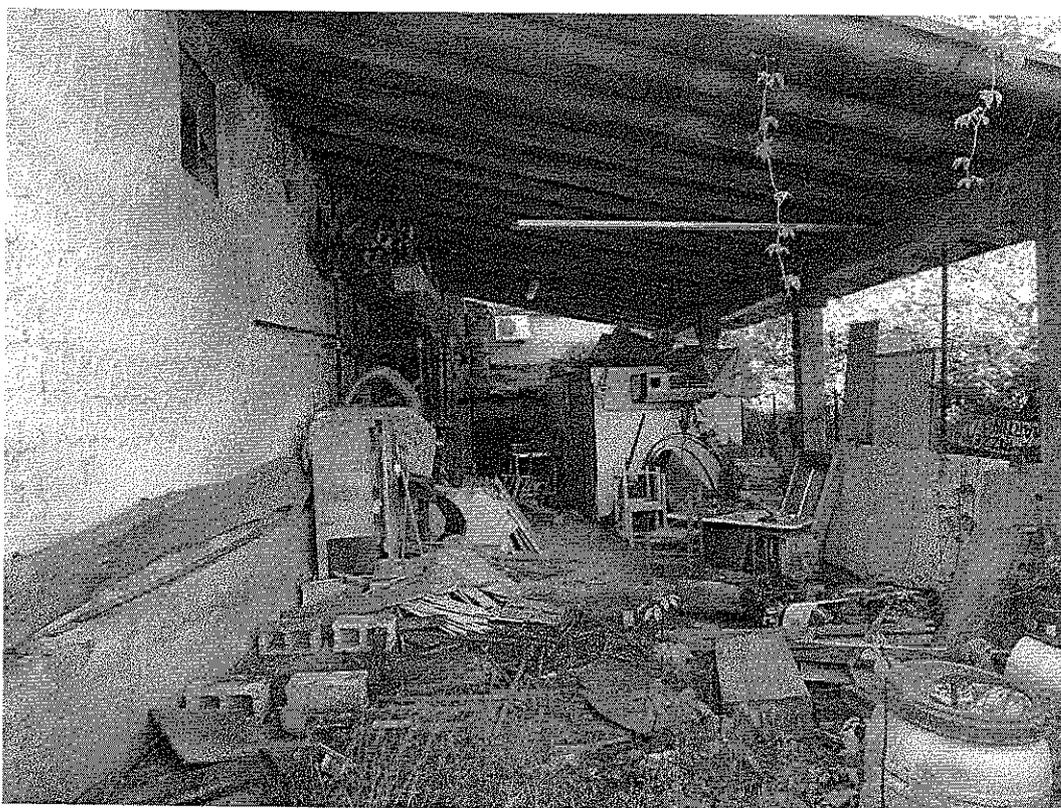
porticato in legno di mq 67 addossato ai prospetti Nord-Ovest del magazzino
